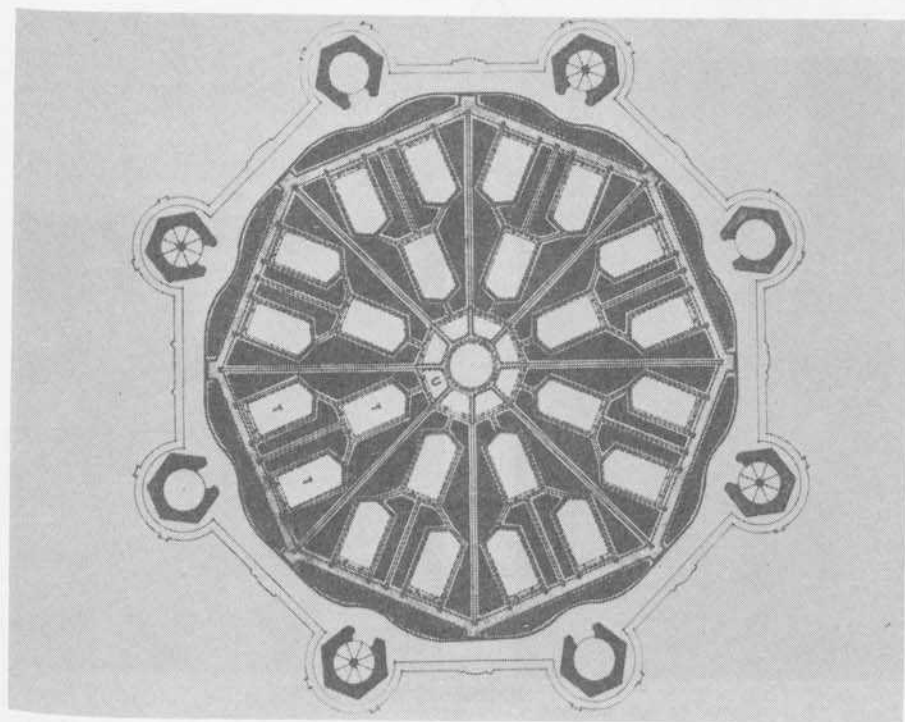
Cubierta calada con lucernas en el Cimborrio. Vista aérea (en proyecto)
